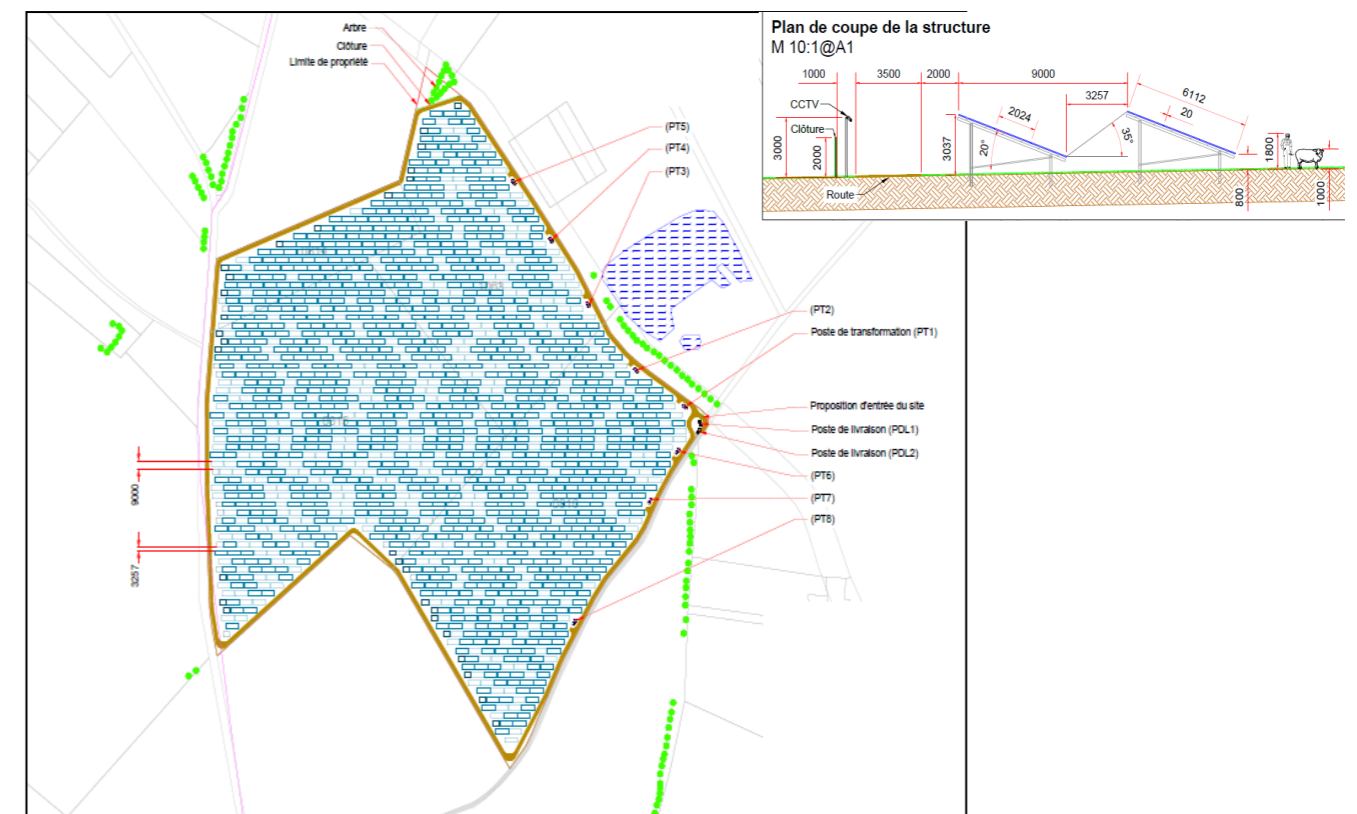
Plan de masse de la centrale PV (version non retenue)
